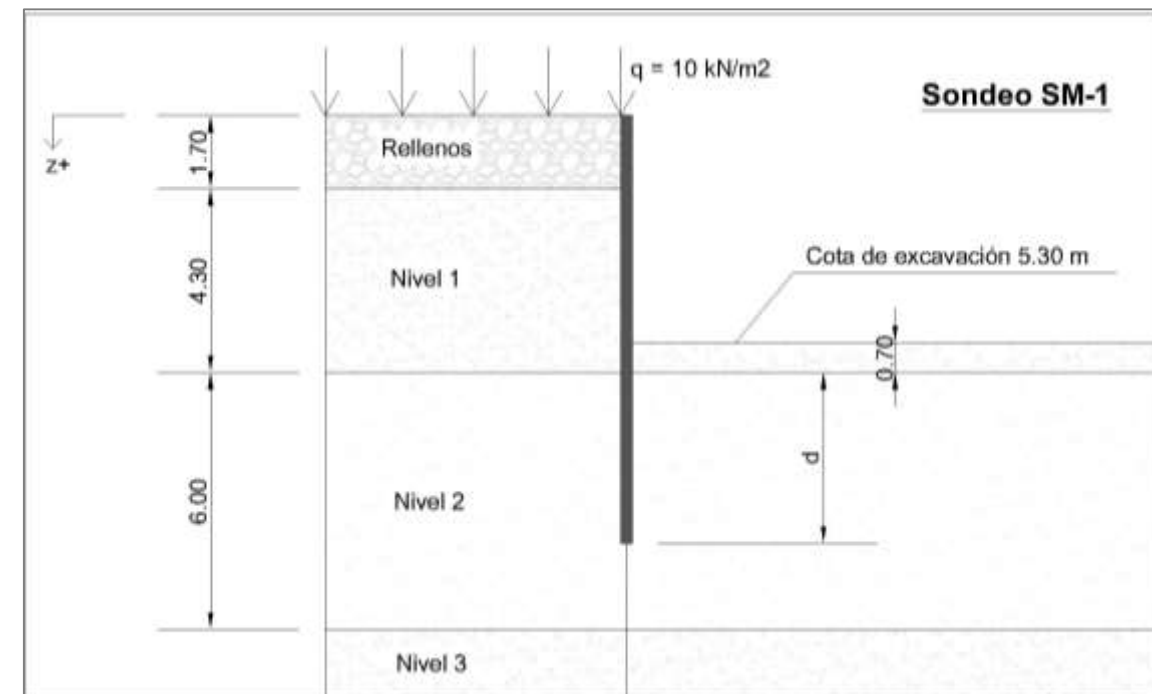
Terreno en el estribo Sondeo SM-1 para la excavación sin acodalamiento. Fuente: Imagen realizada con AutoCad.
